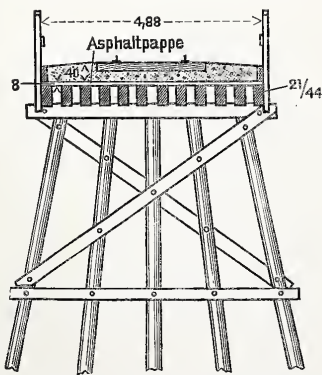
Hölzerne Jochbrücke mit durchgehendem Kiesbett.
